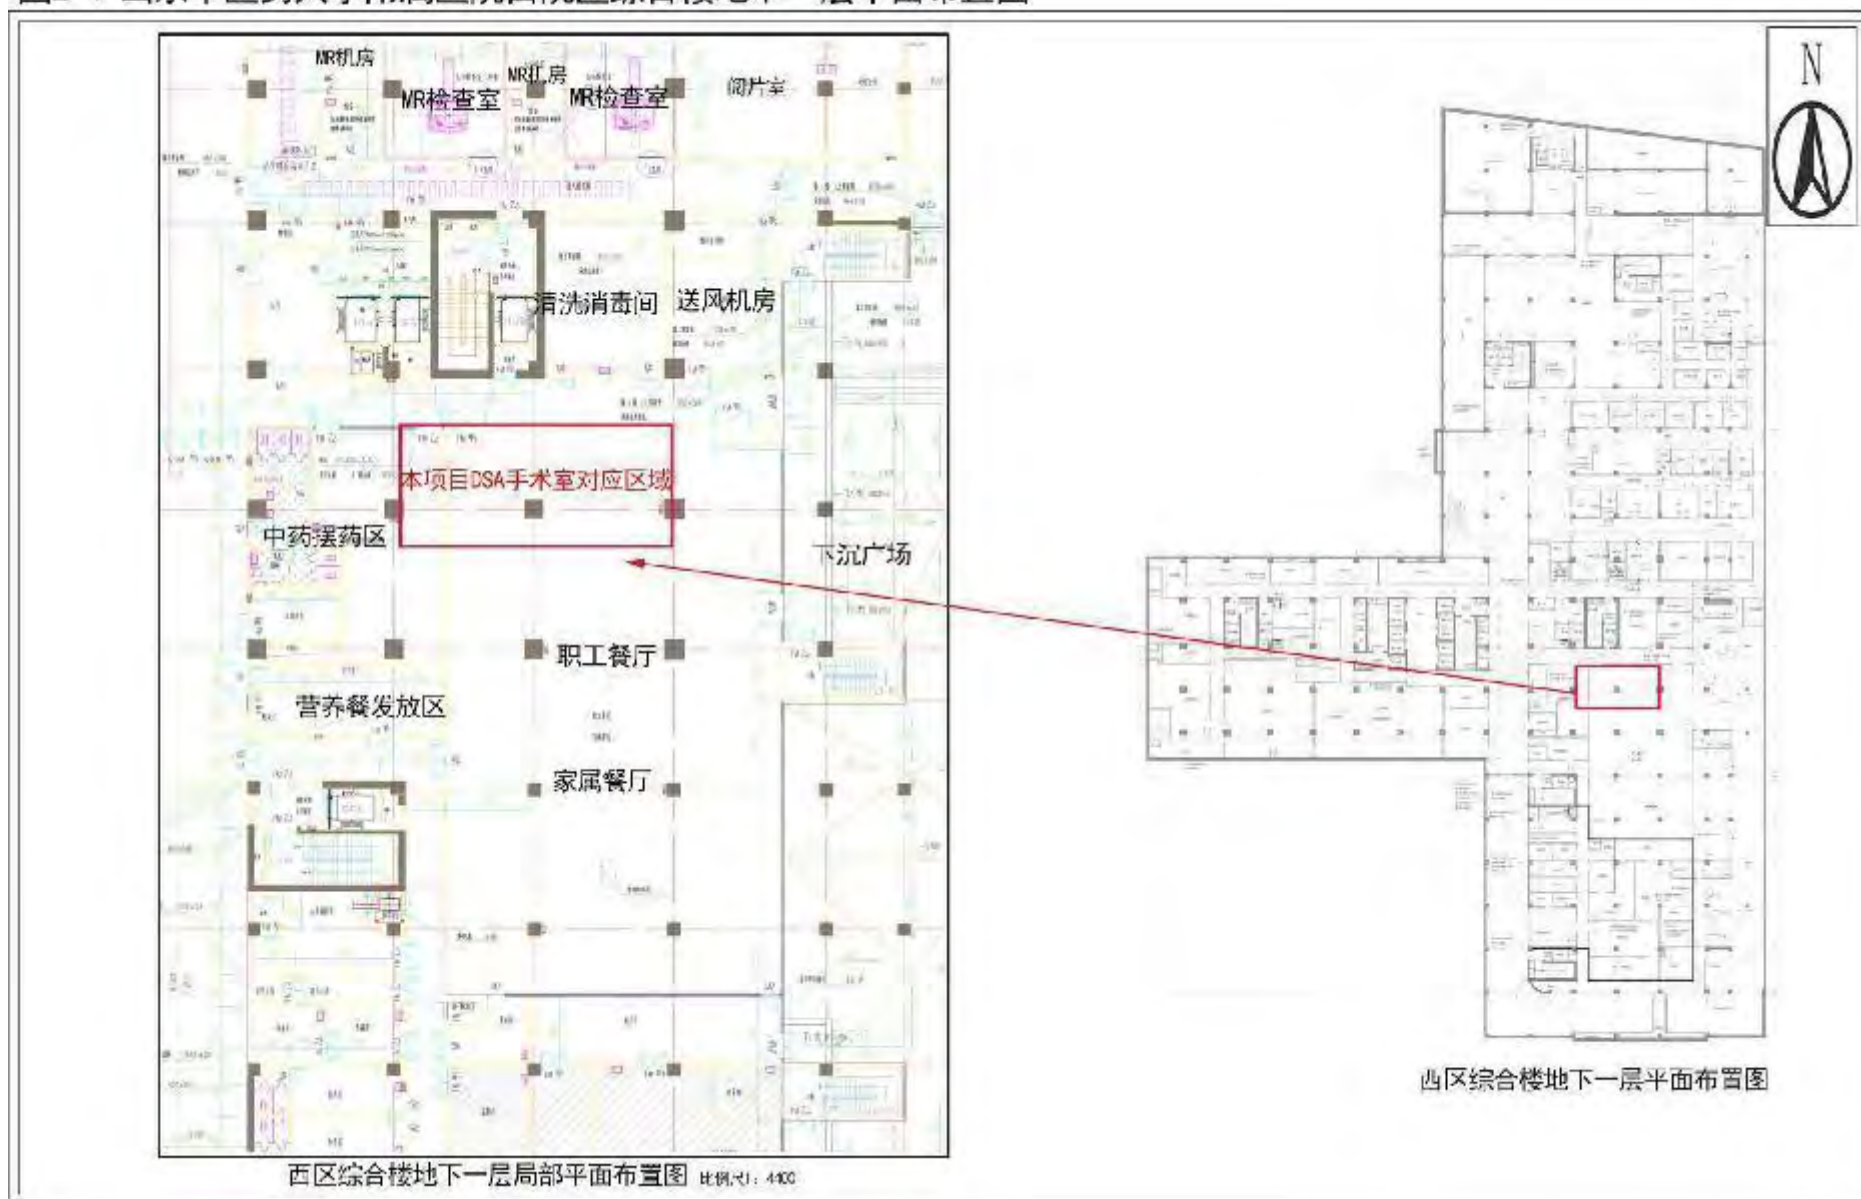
山东中医药大学附属医院西院区综合楼地下一层平面布置图
